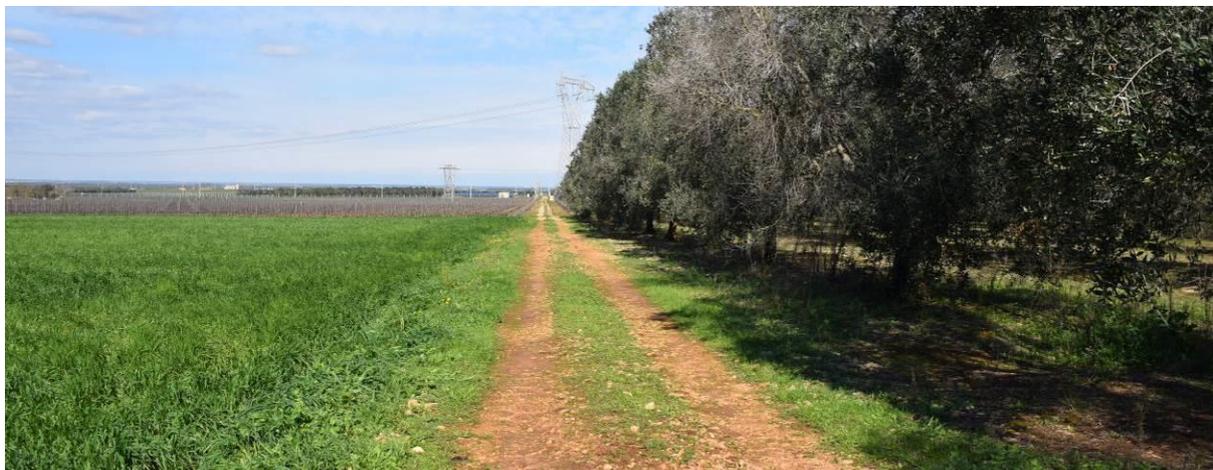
Ultimo tratto della strada in terra battuta di accesso all'aerogeneratore A01. Come si scorge dalle fotografie, è evidente la necessità di adeguamento della viabilità esistente dal tratto in cui parte la carrareccia esistente dalla strada comunale asfaltata.
